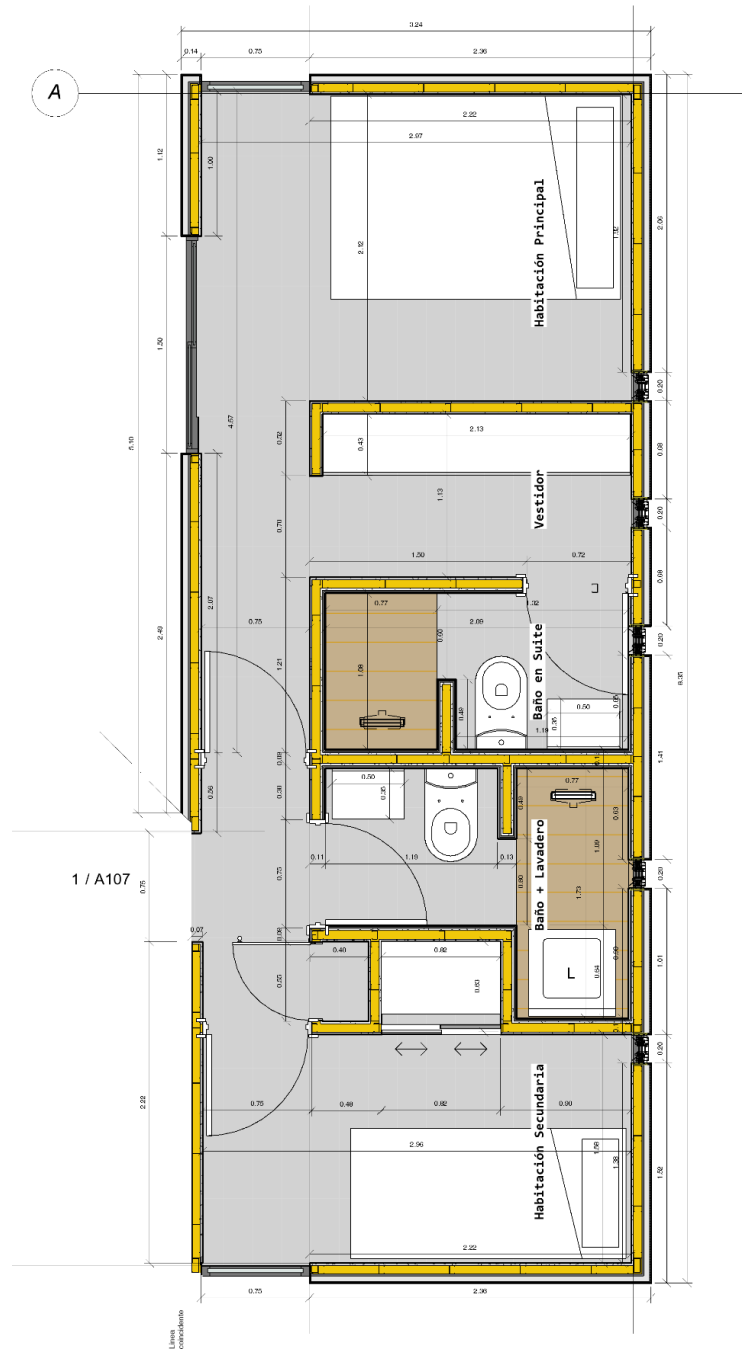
Plano de Planta Módulo 2 de Casa Cero.
